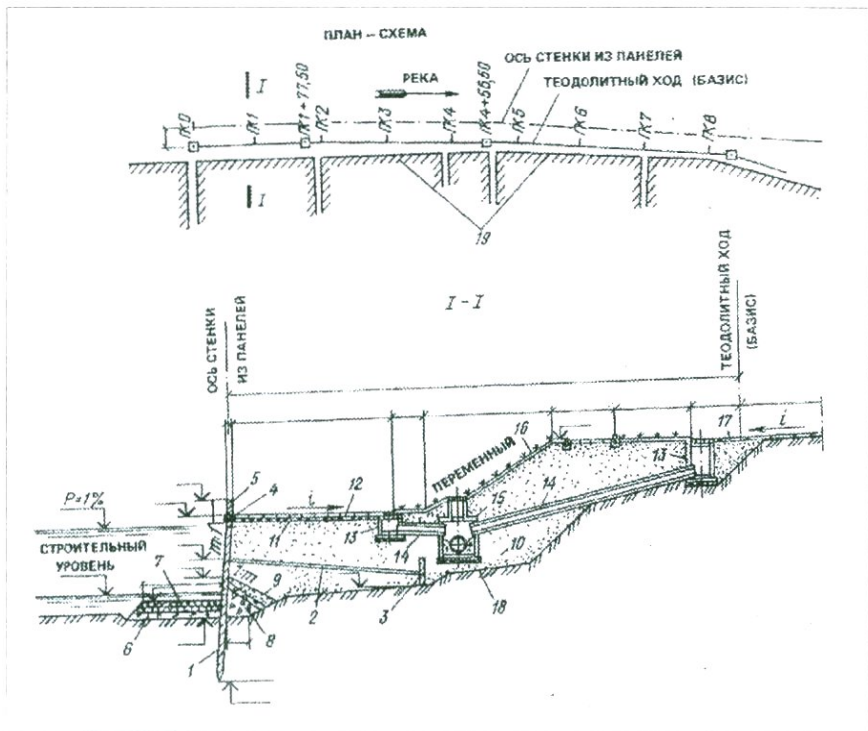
Набережная с вертикальной стенкой из железобетонных панелей.
